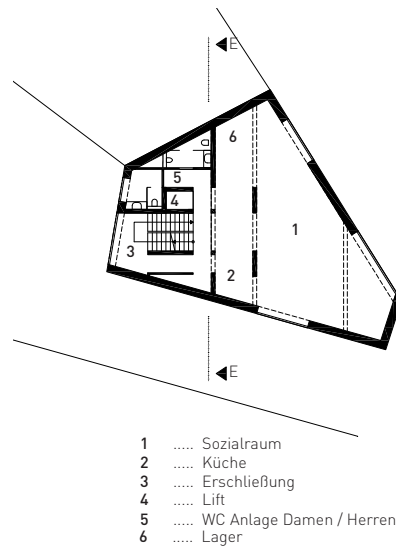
Grundriss Verwaltungsgebäude 3.OG +16,09m
